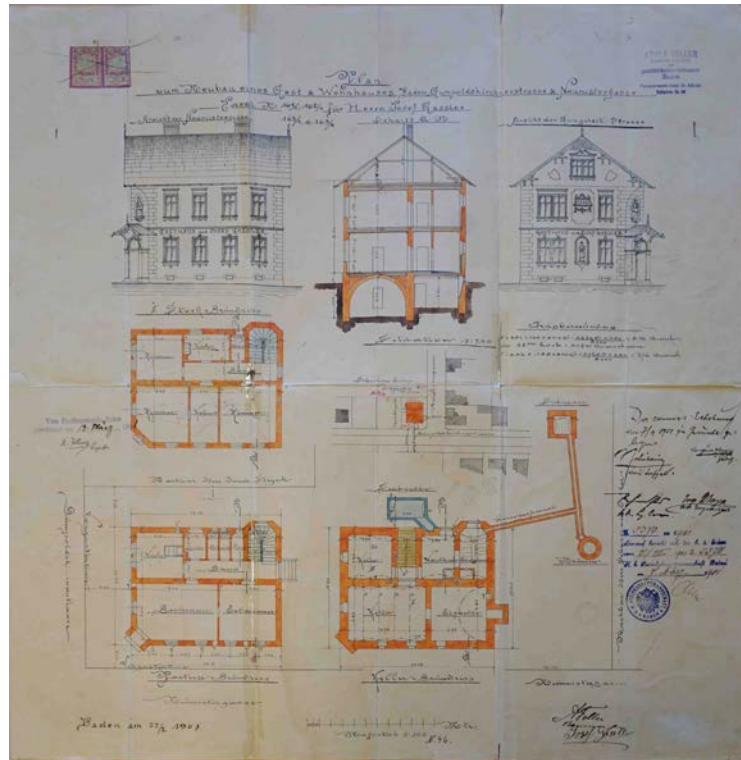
Einreichplan Germergasse 34, 22.2.1901.
